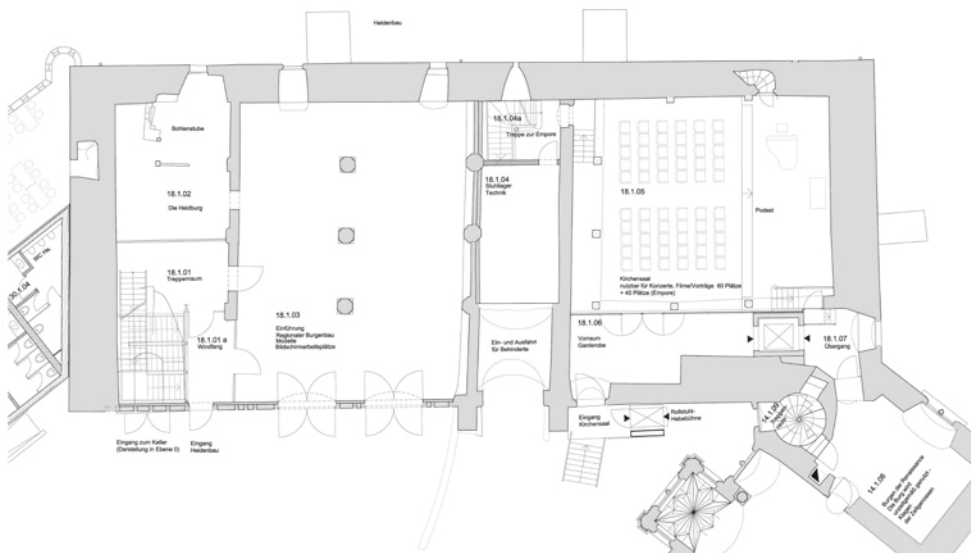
Entwurfsplanung, Grundriss Erdgeschoss, o. M., Zeichnung Architektengemeinschaft Milde + Möser, 2009
